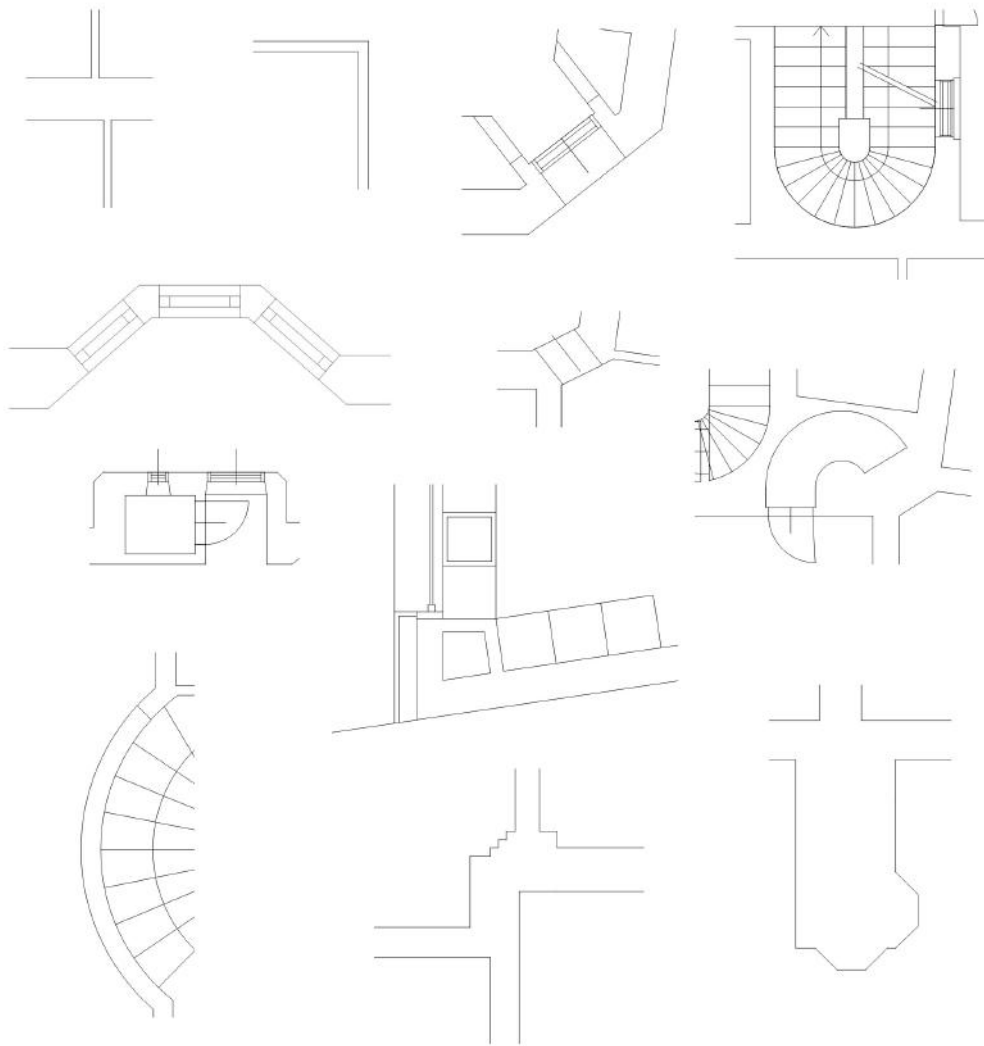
Ausschnitte von möglichen Wandformen in Grundrissplänen.
